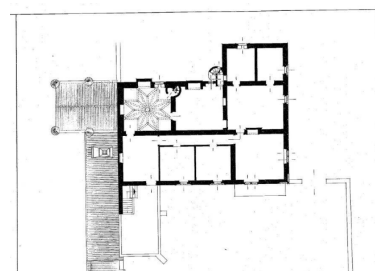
Planta do piso 1 do Paço da Sempre Noiva.
